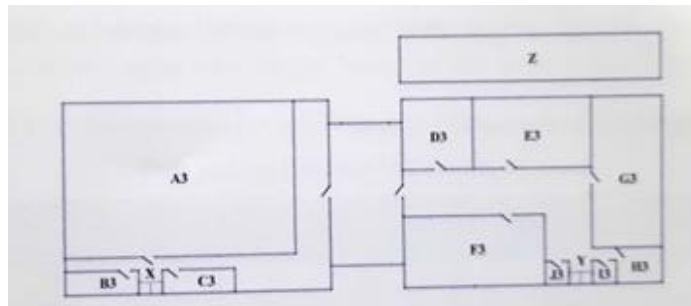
Denah ruangan pada lantai 2 Gedung Rektorat Lantai 2
